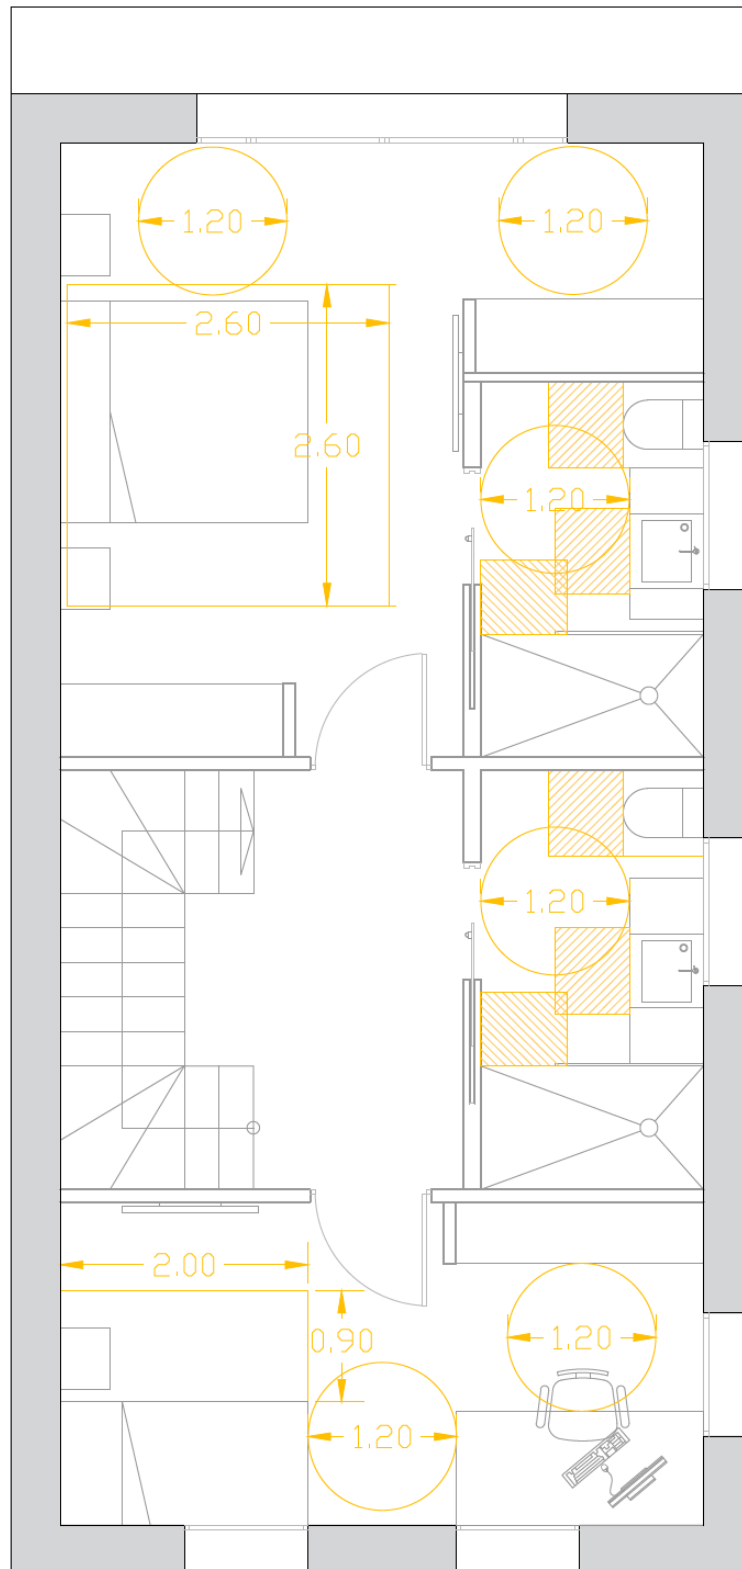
Plano normativa planta primera 2019. Fuente propia.
